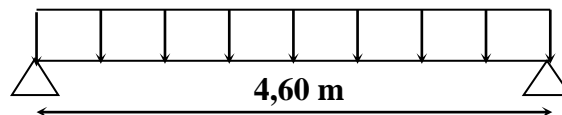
Schéma statique de la poutre de chaînage à l'ELU.
